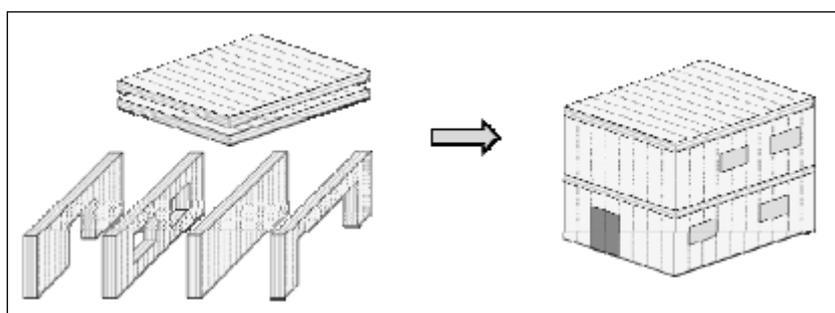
Struttura portante dell'edificio formata da elementi piani.
